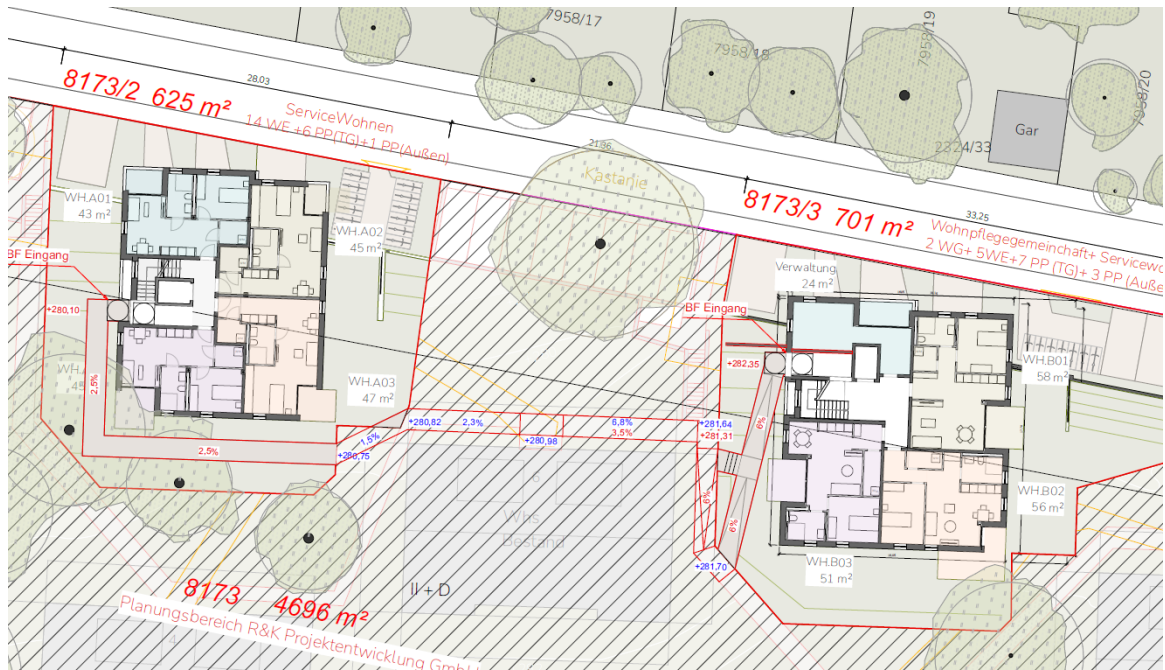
Lageplan Erdgeschoss vom 23.01.2025, © AP+M ARCHITEKTEN GmbH
